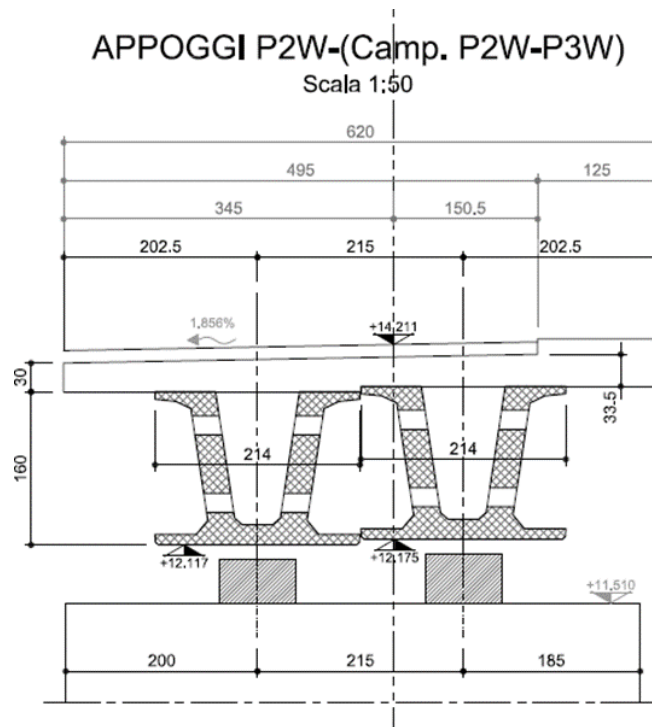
Sezione trasversale Campata 3 (a 2 travi) – Rampa W – P2_W
